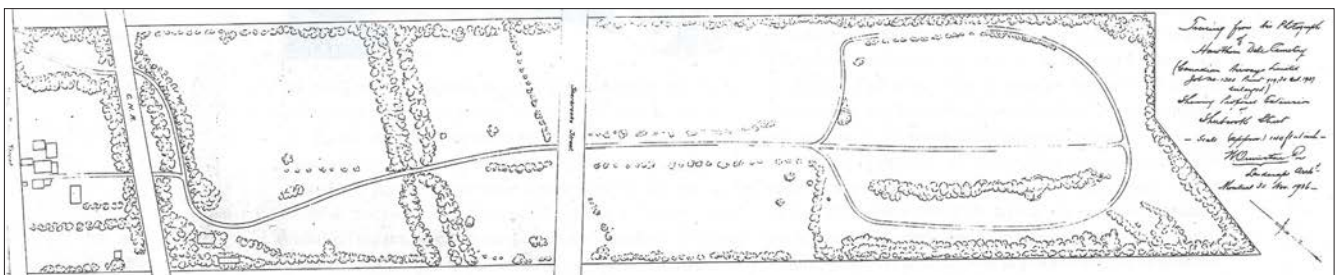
Plan du cimetière Hawthorn-Dale, par Ormiston Roy, 1936.
